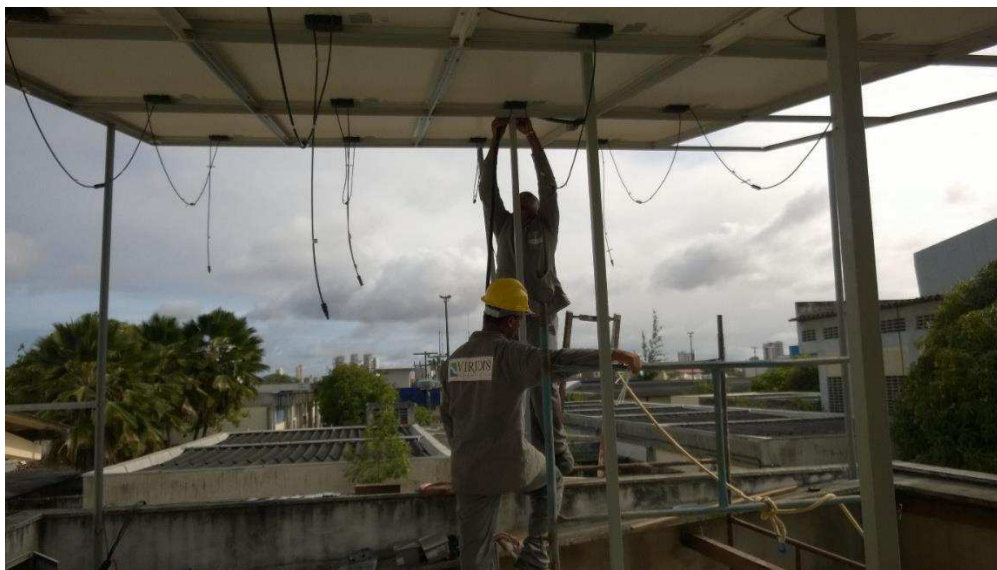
Fotografia da fixação dos arranjos de painéis fotovoltaicos das plantas fixas no suporte metálico no LEPER/UFRN.
